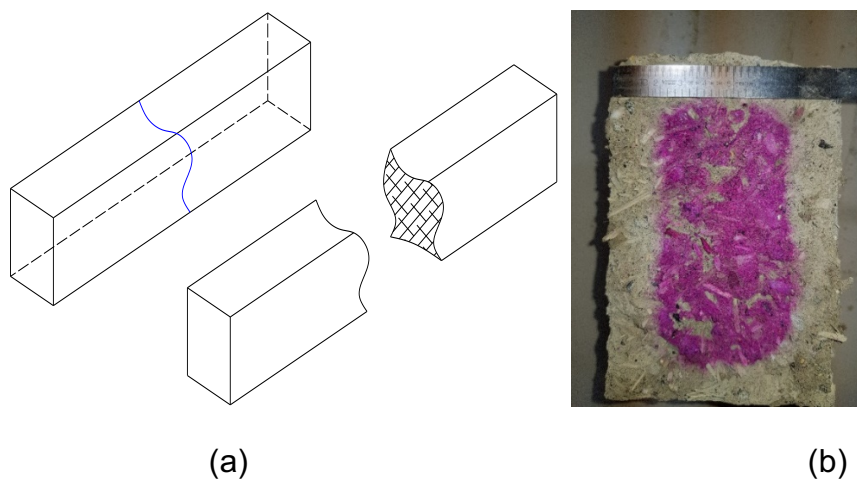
26 : Direction de fendage de la poutre (a) et Section de la poutre après pulvérisation de la phénolphthaléine (b).
